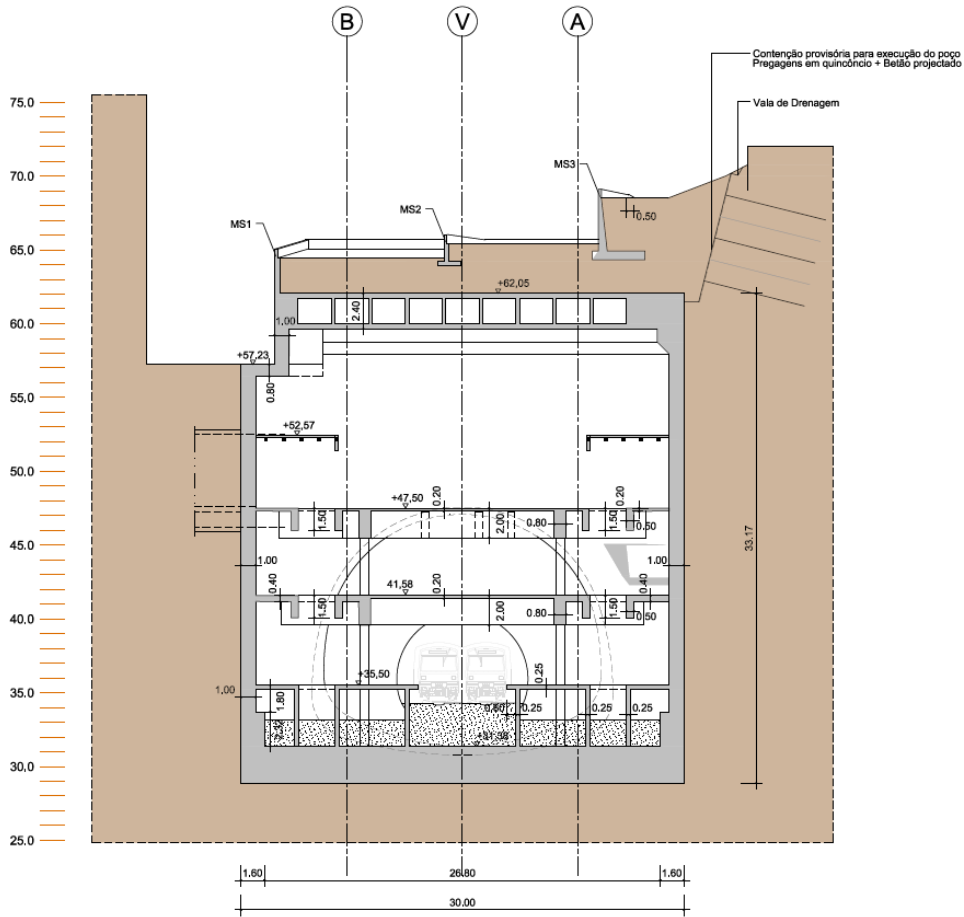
Estrutura do poço principal, estrutura interna e laje de cobertura
